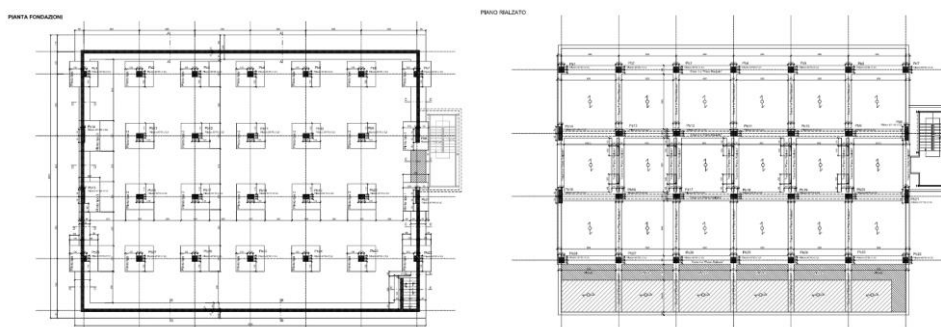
Pianta fondazioni (sinistra) e piano rialzato (destra) corpo B
